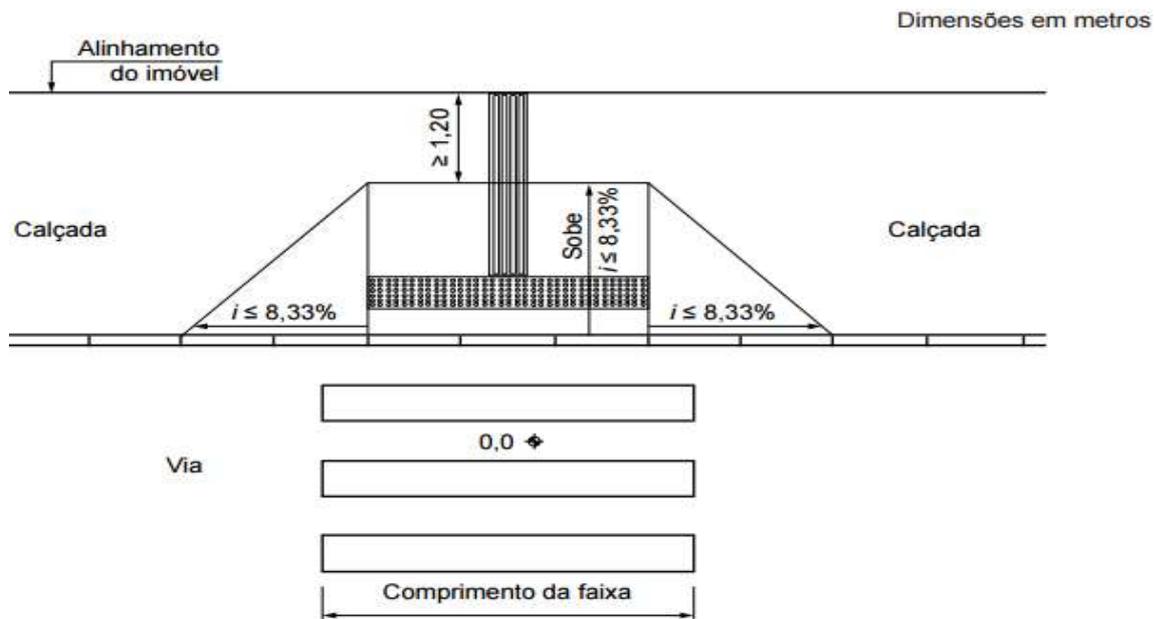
Faixa elevada para travessia - Vista superior. “Lombofaixa”.
